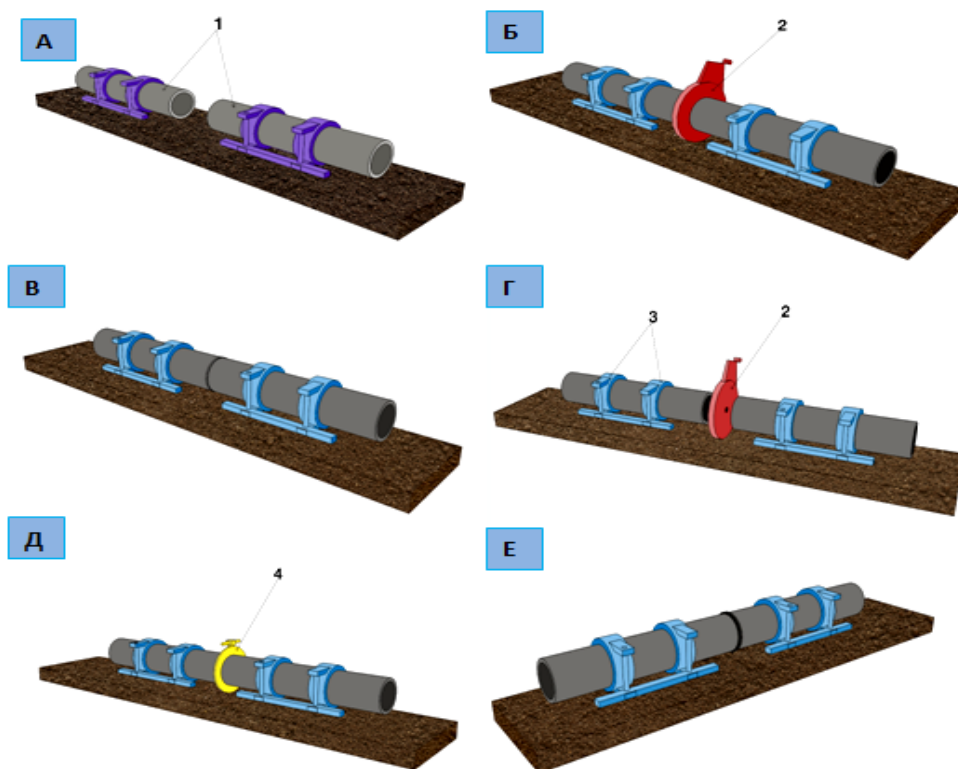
Технологическая последовательность сварки полиэтиленовых труб:
